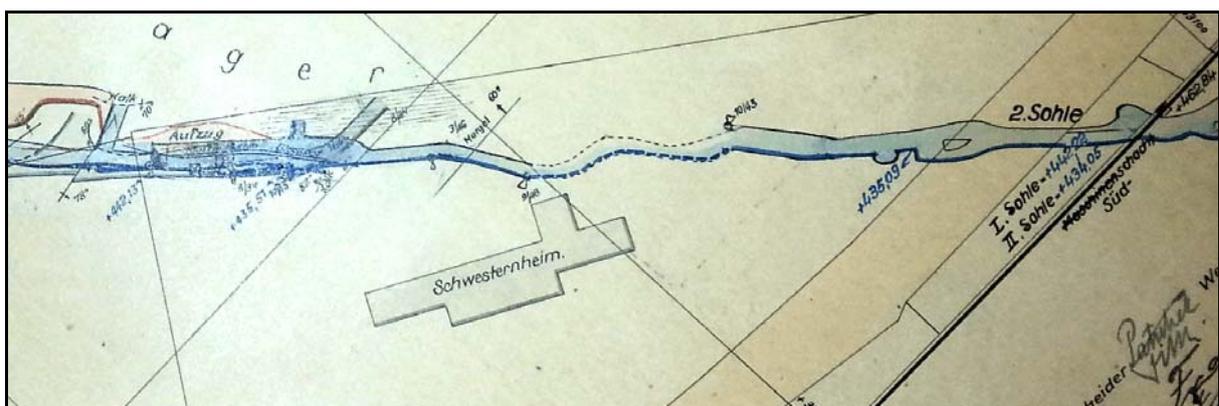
Lageplan Ausschnitt (nicht nach Norden ausgerichtet)
